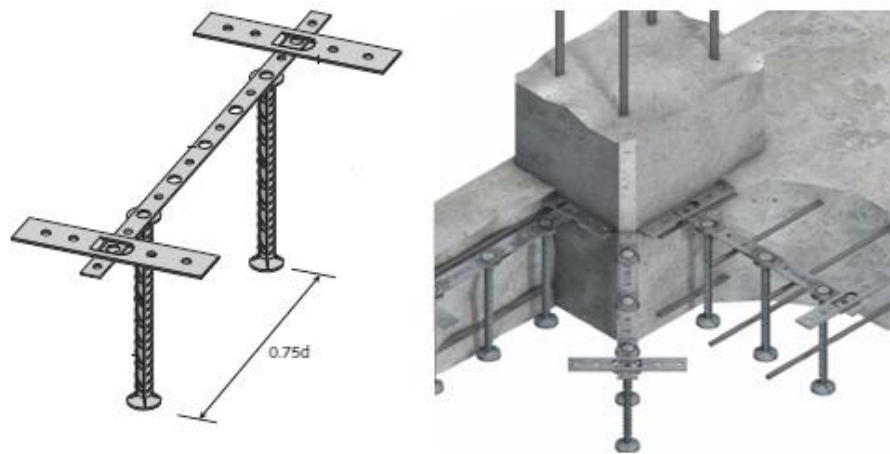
Detalhes do sistema de armaduras – HALFEN DEHA (2007).
